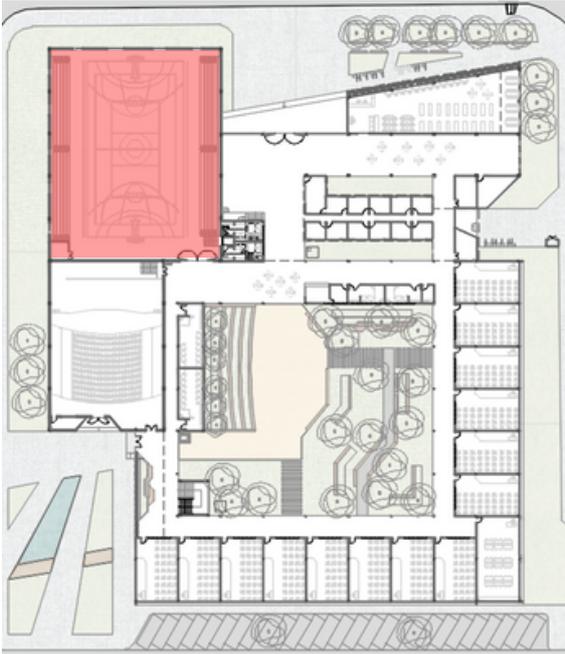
Planta baixa do terreno com localização da quadra, destacada em vermelho. Fonte: Autoria própria.
